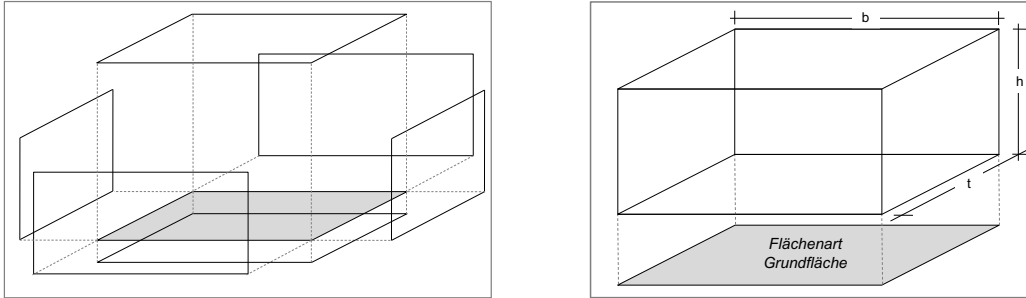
Flächen der grundflächenbezogenen Standardraumstruktur
